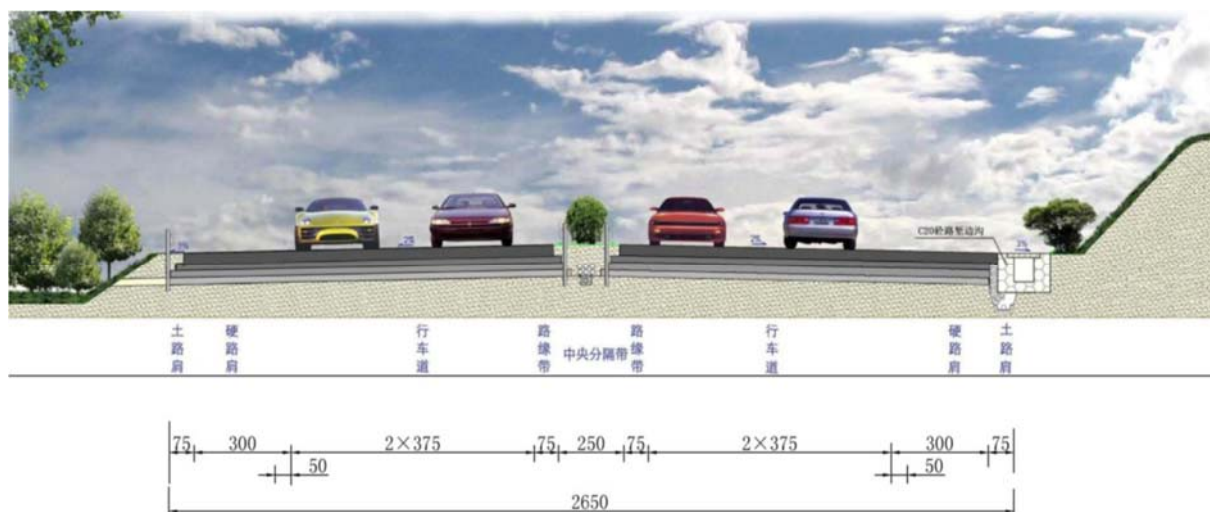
主线整体式路基横断面图 (路基宽 26.5m)
